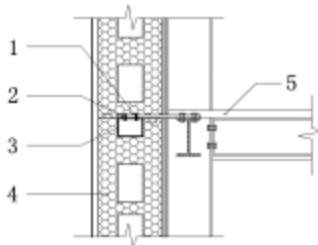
墙体水平芯肋与结构边梁连接组合构造示意
